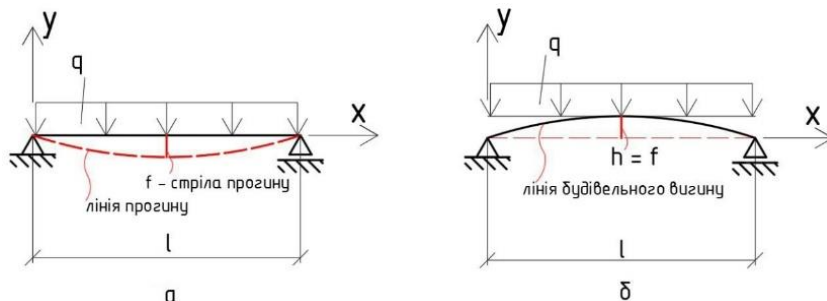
Схема шарнірно опертій двохопорної балки:
